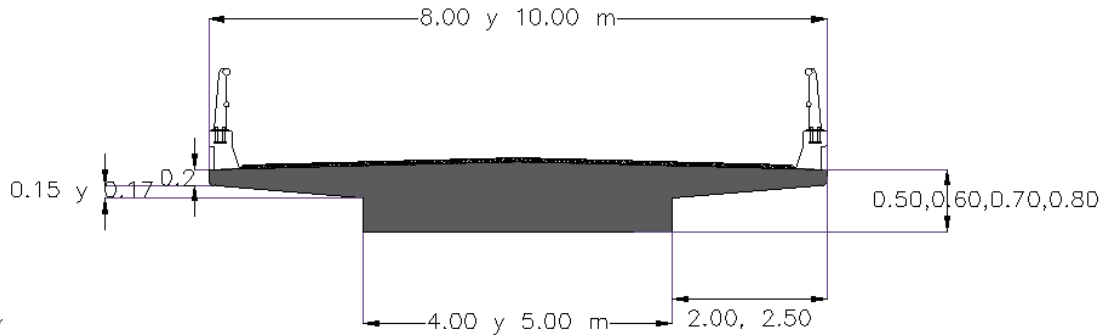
Sección transversal tipo de puente con losa plana maciza
